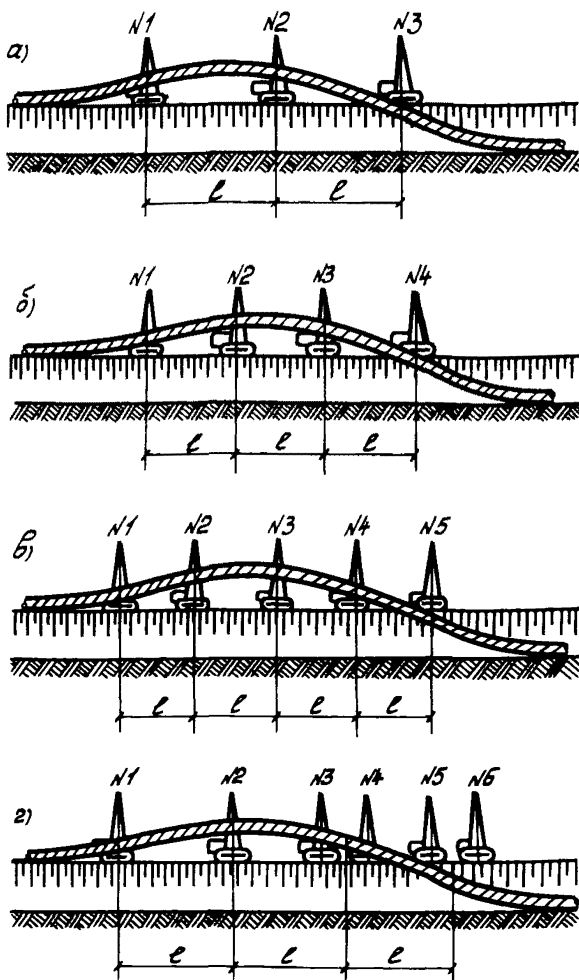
Схема расположения трубоукладчиков при раздельной укладке изолированного трубопровода с применением мягких монтажных полотенец.
